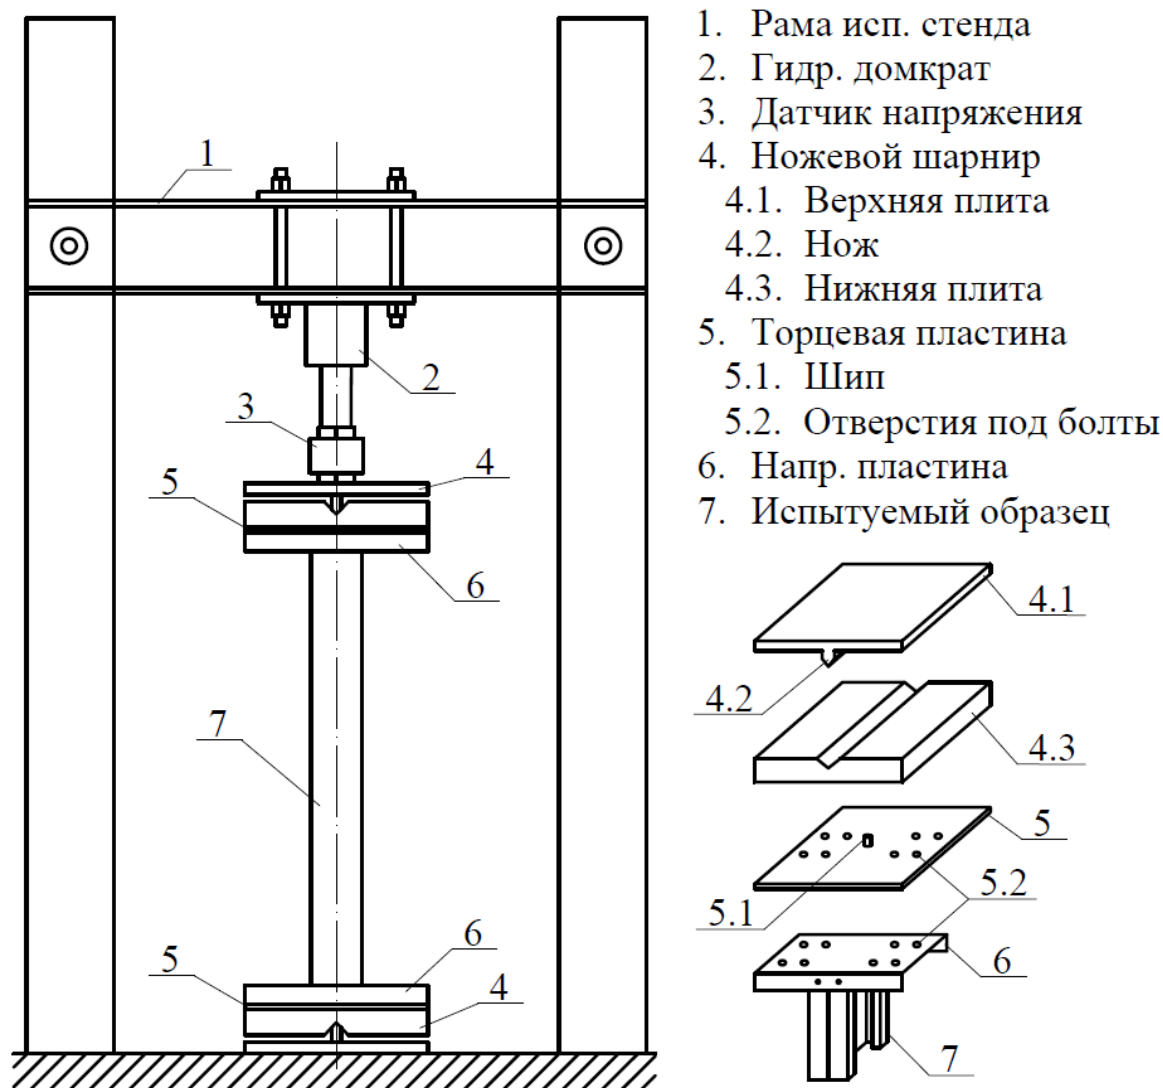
Принципиальная схема испытательного стенда [163]
